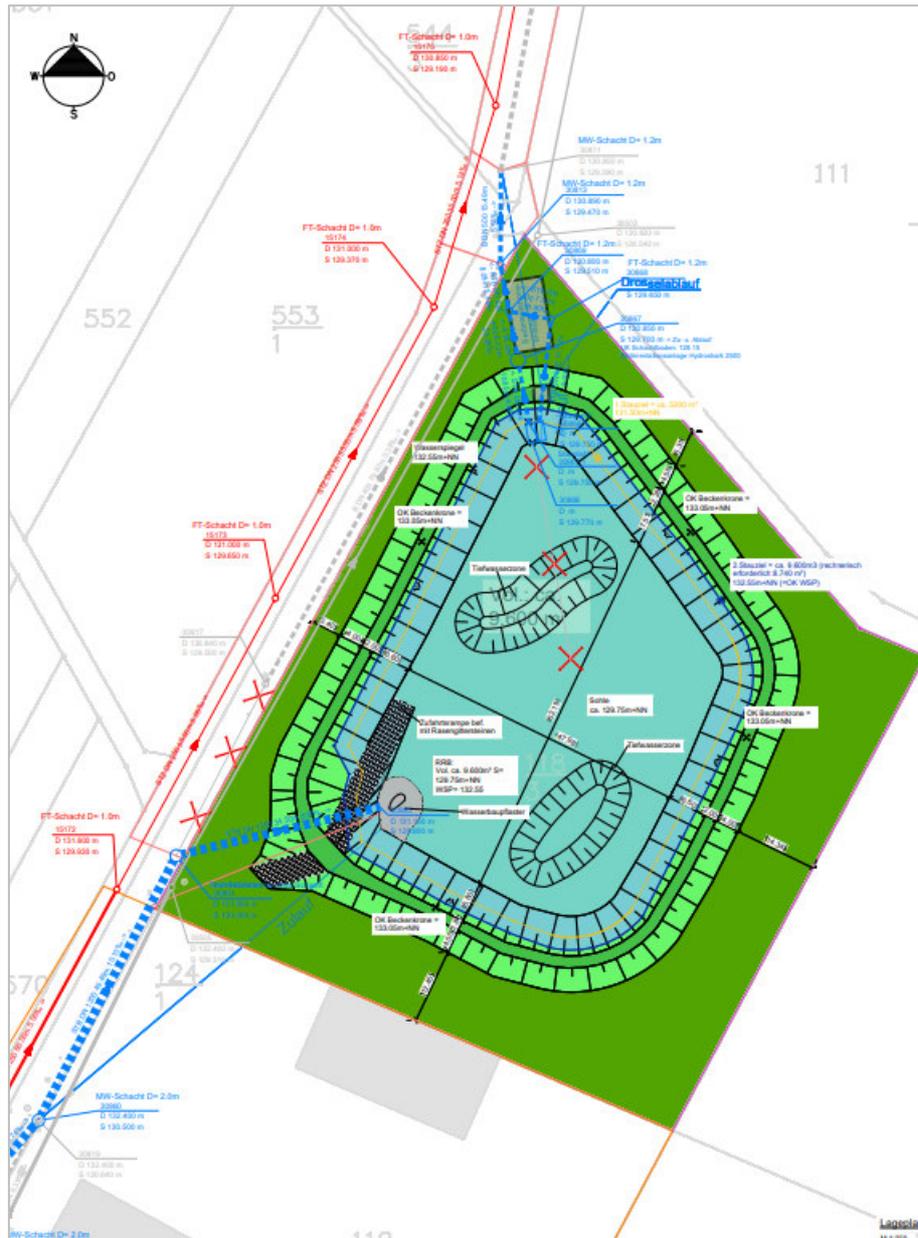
Detailplanung RRB 1 (Best Ingenieure GmbH, Anlage 310.1 Erläuterungsbericht)
